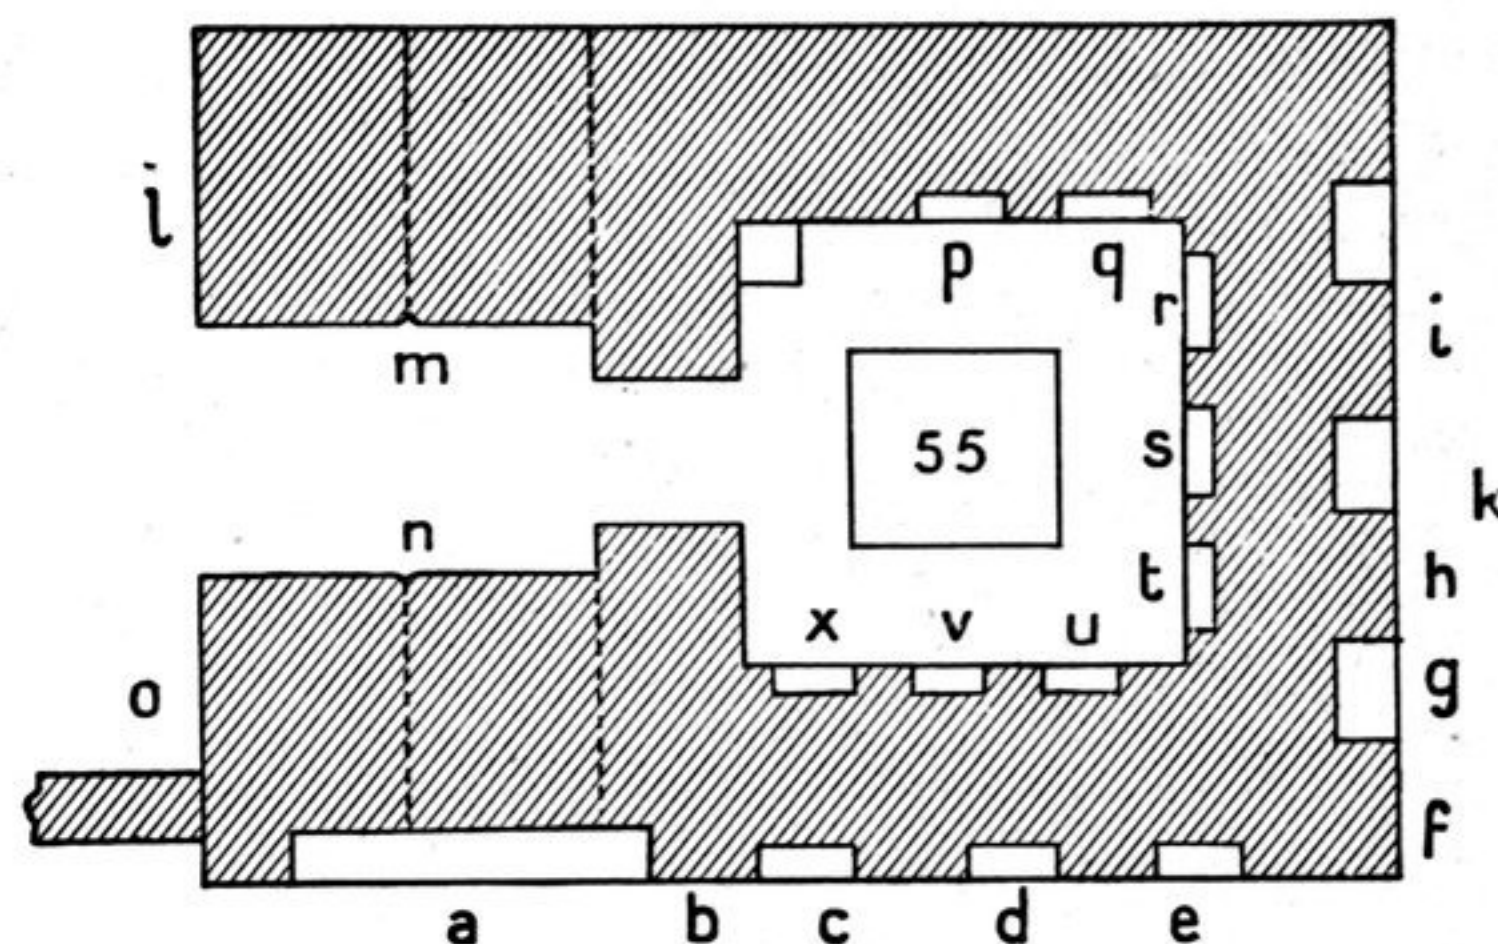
Plan du *vihāra* B, 56; au centre : B, 55.
